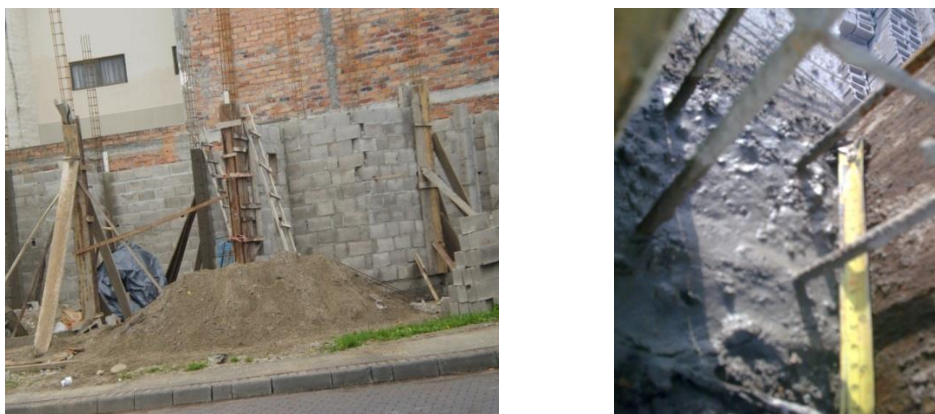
Encofrado de columnas, se utiliza técnicas artesanales para construir cada una de estas. Colocación de hormigón elaborado en obra. Edificación de tres plantas, área de construcción 532 m<sup>2</sup>. Arq. Manuel Cabrera. Av. González Suarez.
